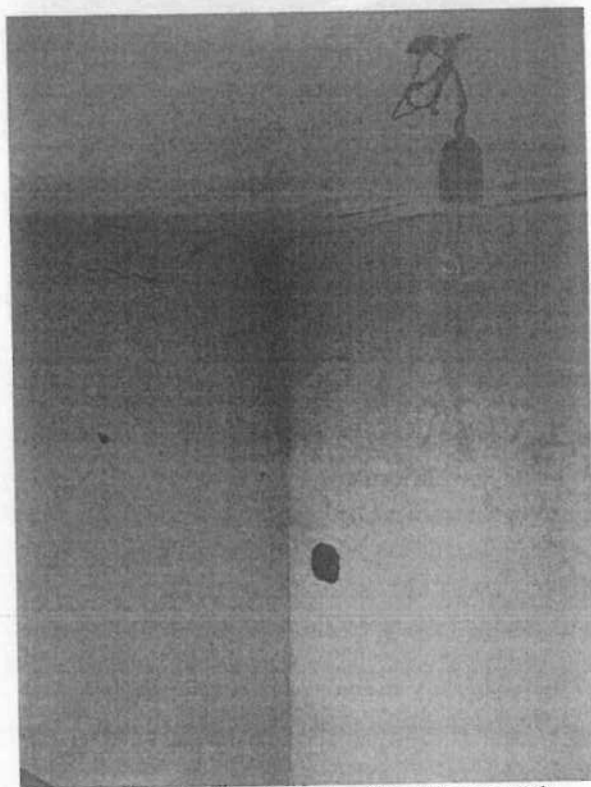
Infiltrazioni sul soffitto del vano scala.
